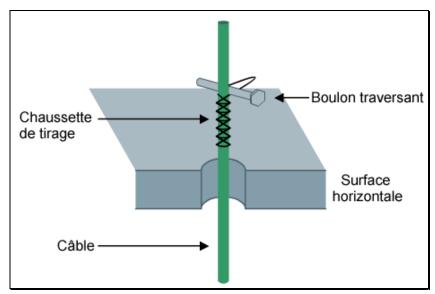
Chaussette de tirage fixée à l'aide d'un boulon traversant
